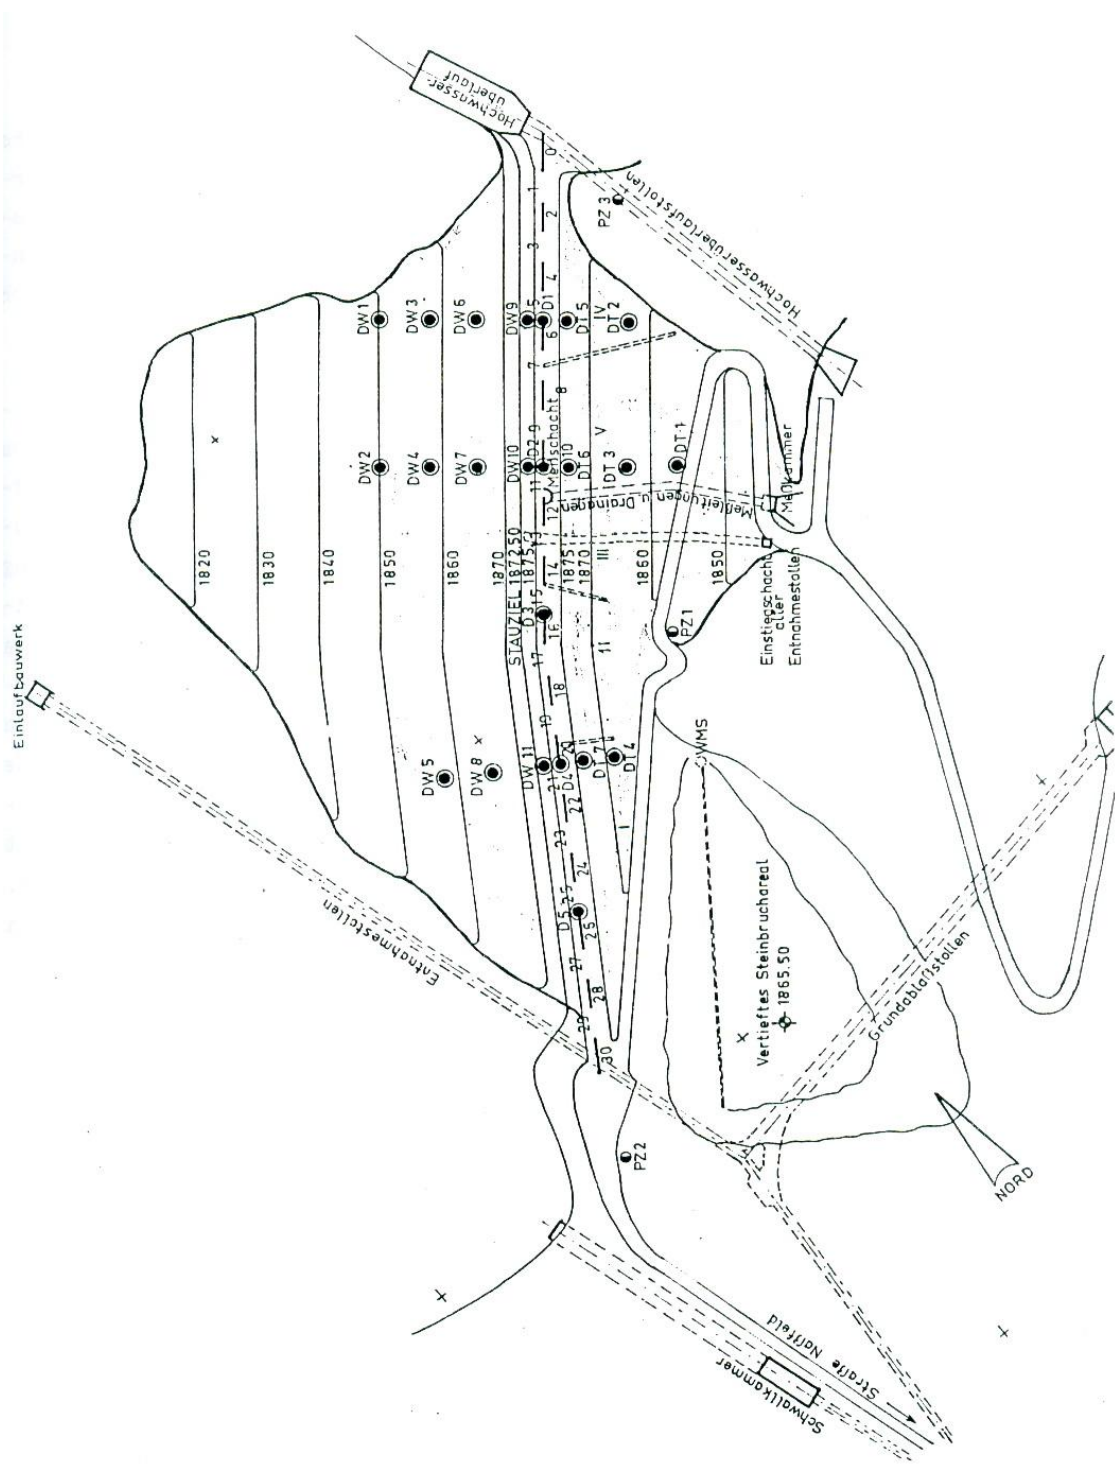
Lageplan mit Messeinrichtungen aus: [36]
